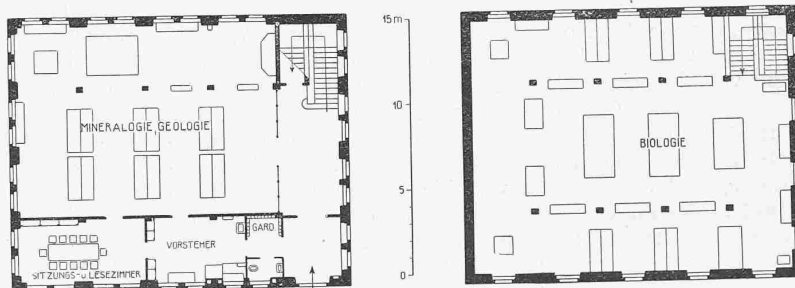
und 3. Grundrisse des Erdgeschosses und des ersten Stocks. — Masstab 1 : 400.
